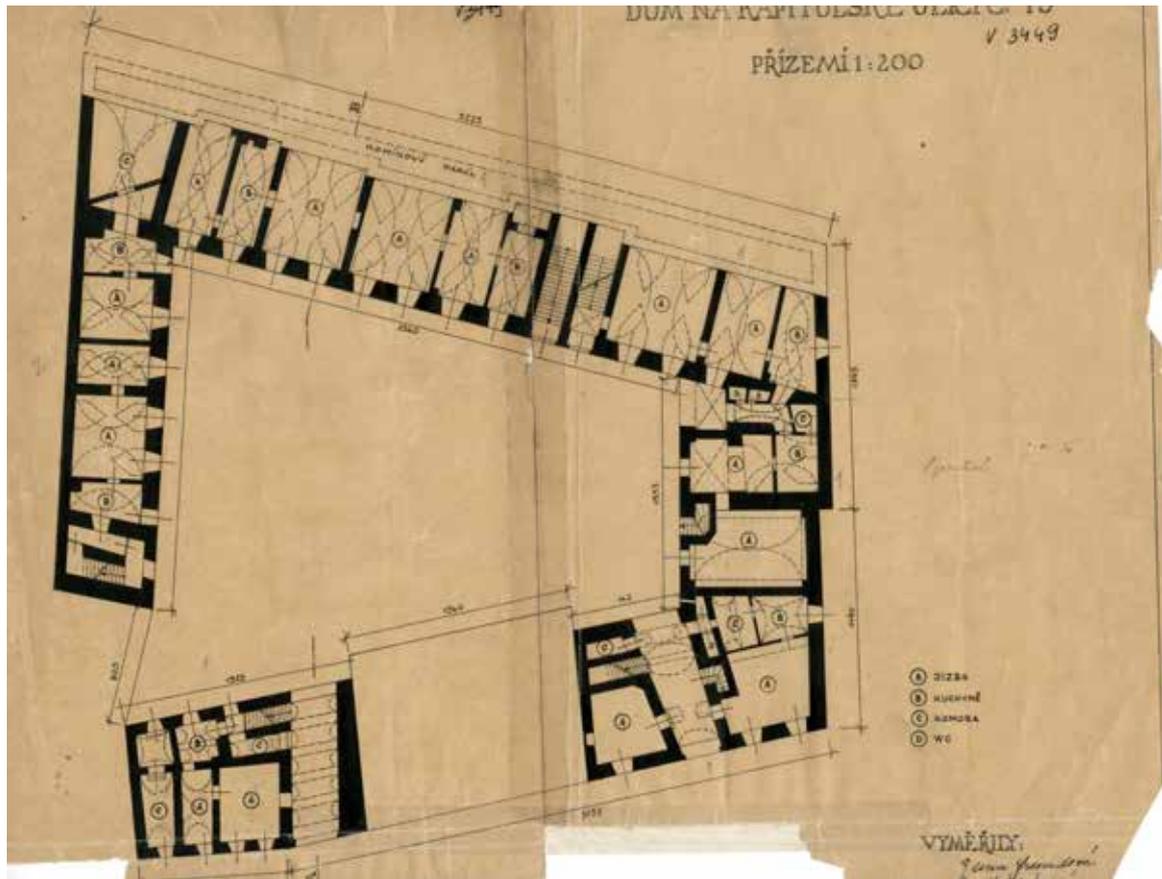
Grundriss Erdgeschoss, Zeitpunkt der Zeichnung unbekannt
